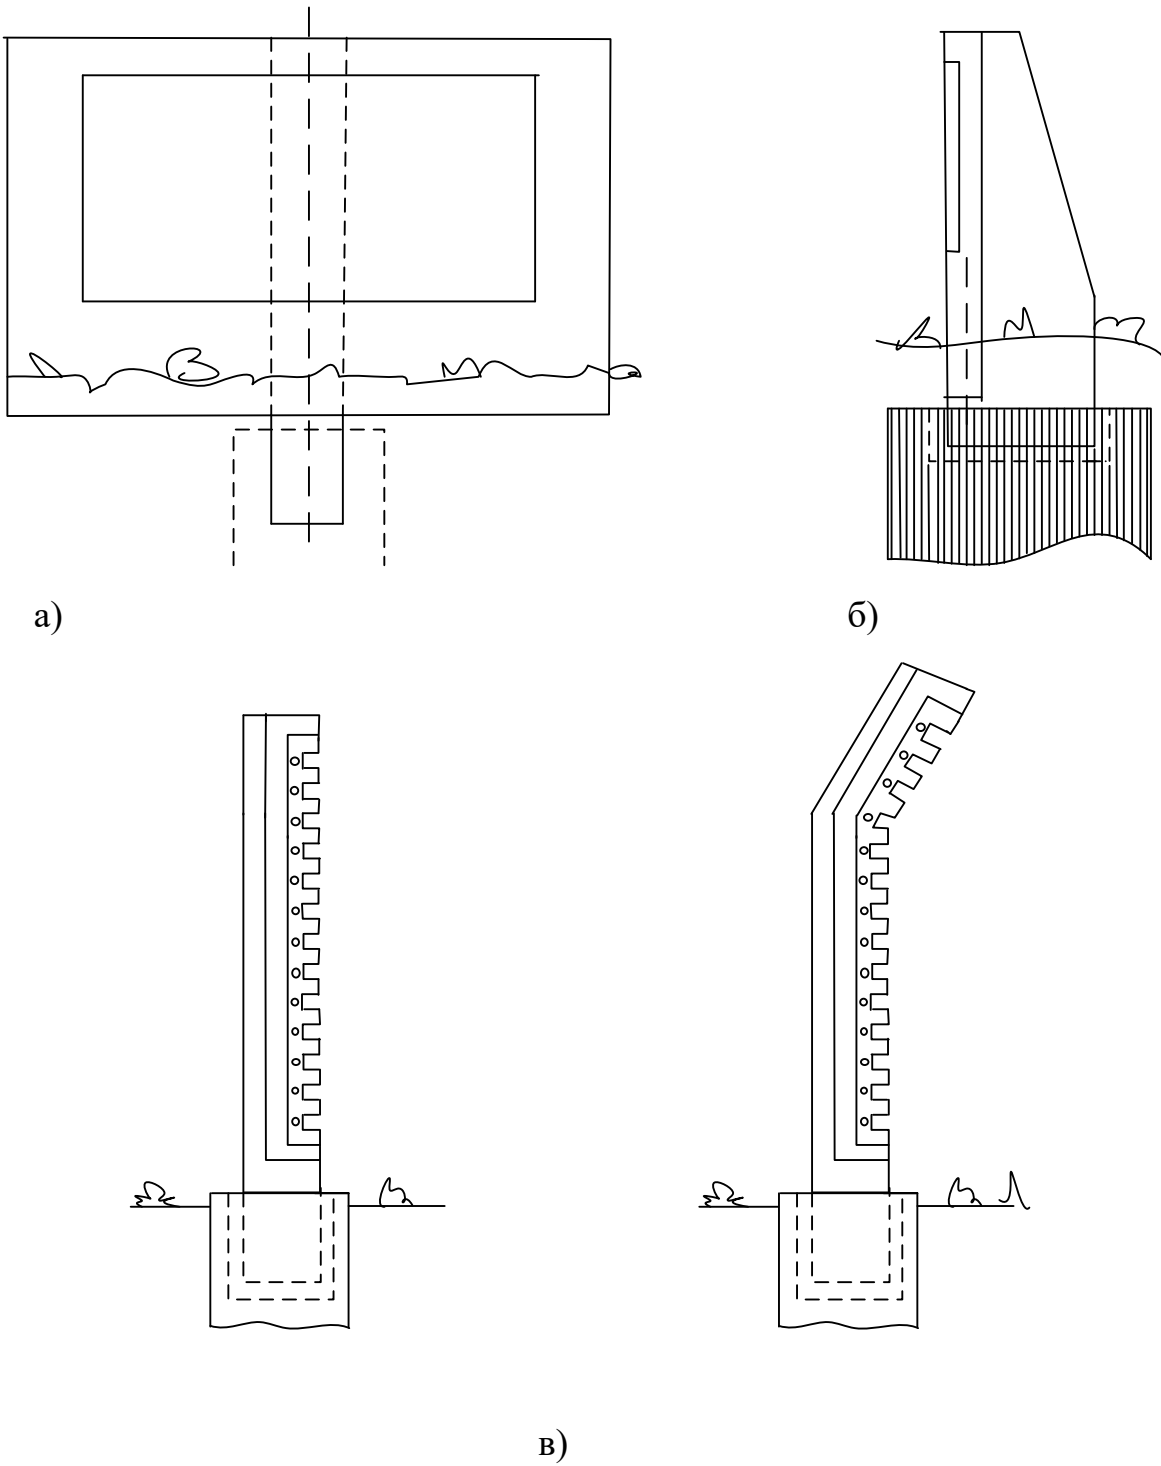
Екран із залізобетону: а) фасад; б), в) розрізи
